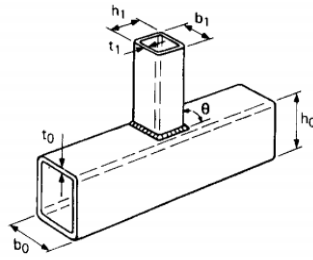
Soldadura en Perfiles Tubulares
